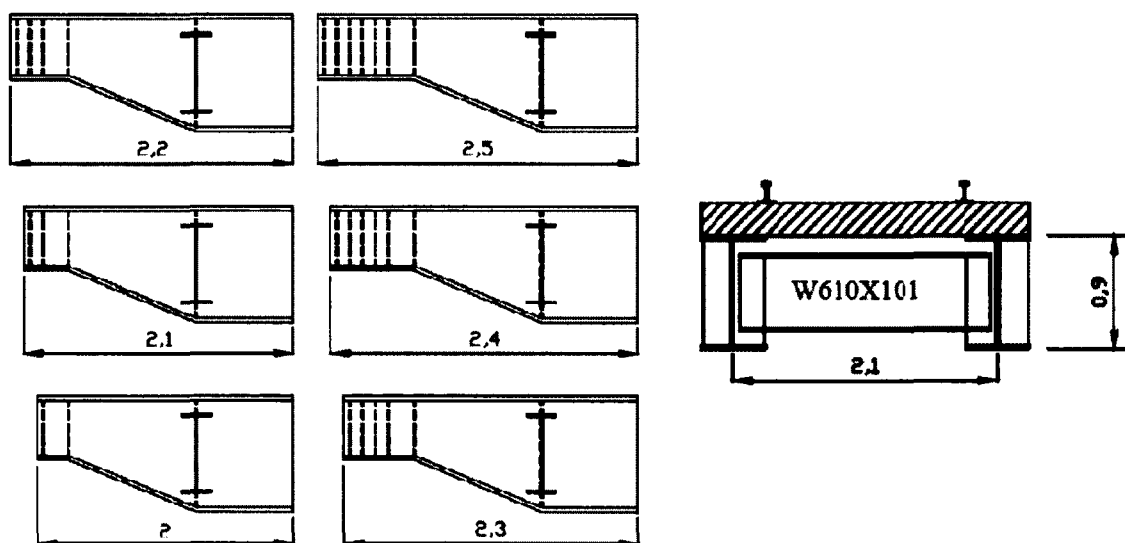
Pont bi-poutres - Ajustement de la longueur - Section A
